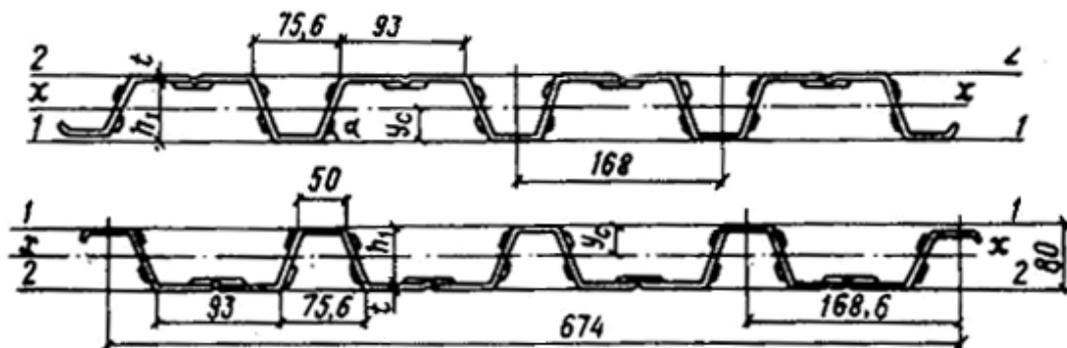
Стальной профилированный настил, рекомендуемый для монолитных перекрытий
